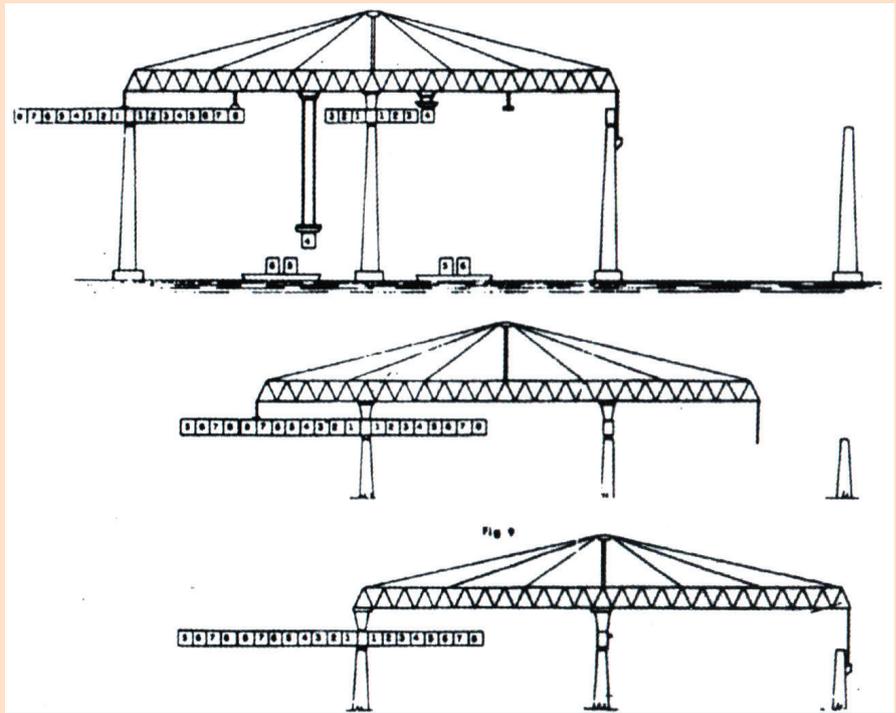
SEQUÊNCIA DE MONTAGEM COM TRELIÇA AUTOLANÇADEIRA [7]
